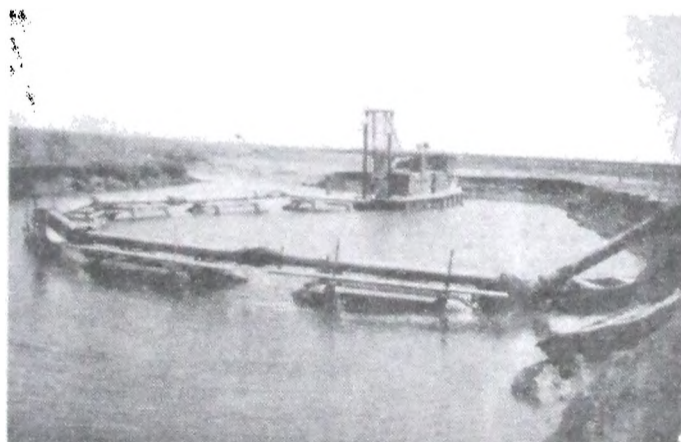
Desagüe del partido de General Paz. Canal de la Laguna de Ranchos al Arroyo Vitel. Máquina excavadora trabajando
